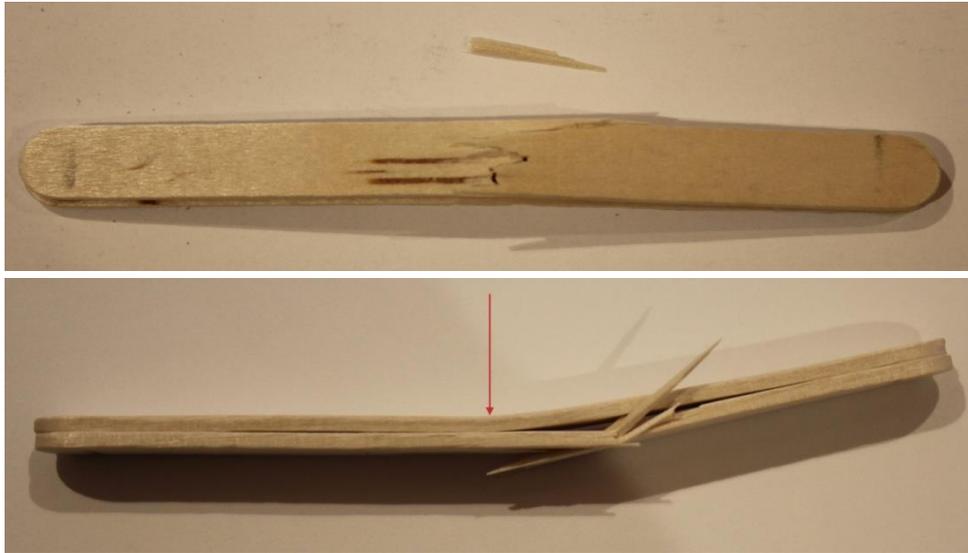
Exemple d'essai sur bâtonnet défaillant
